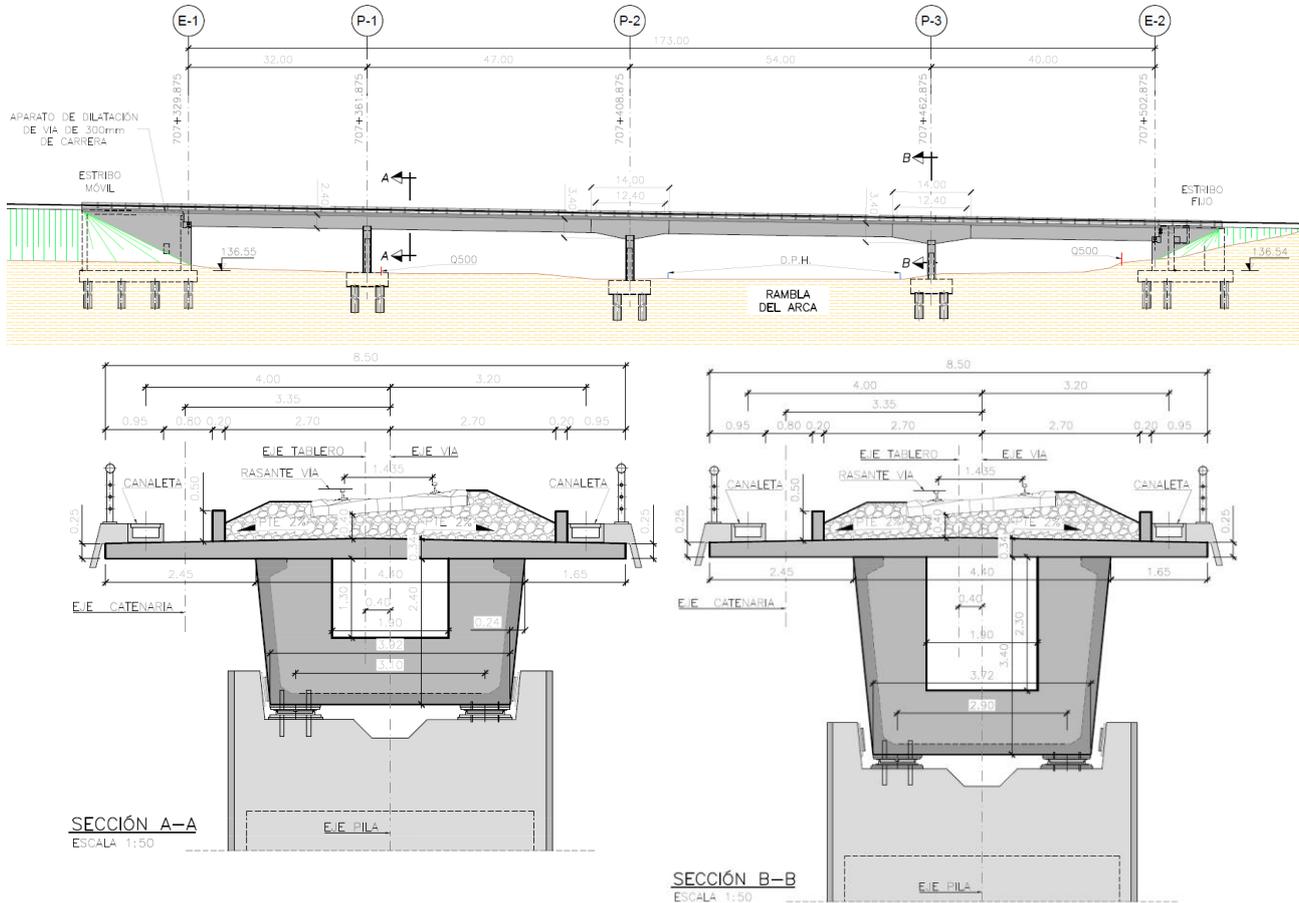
Viaducto sobre la Rambla del Arca. Alzado longitudinal y secciones sobre pila.
